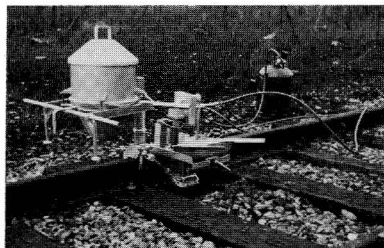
Ensemble de soudure aluminothermique
